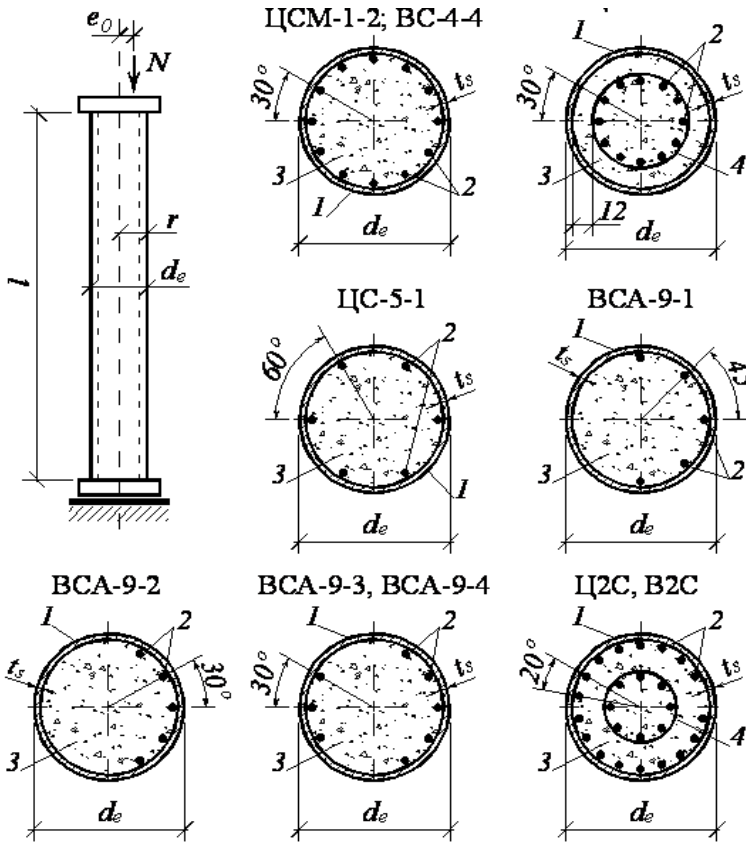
Загальний вигляд та перерізи дослідних трубобетонних зразків із додатковим поздовжнім армуванням: 1 – труба-оболонка; 2 – стрижнева арматура; 3 – бетонне заповнення; 4 – кільцевий хомут
